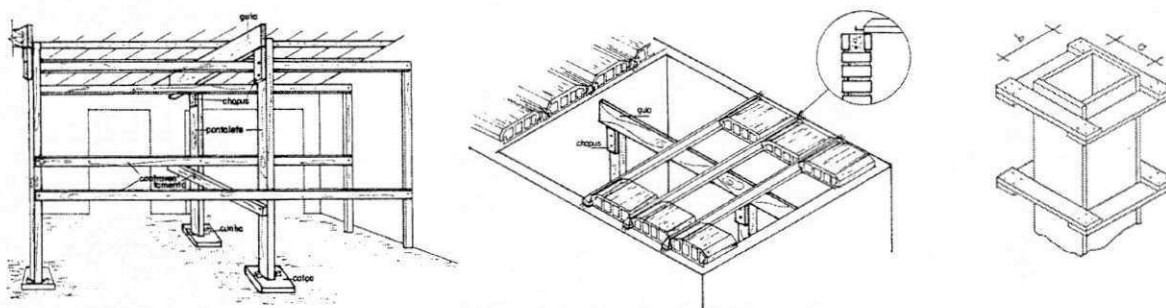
Forma para Pilar e Escoramento para Laje Pré-Moldada
